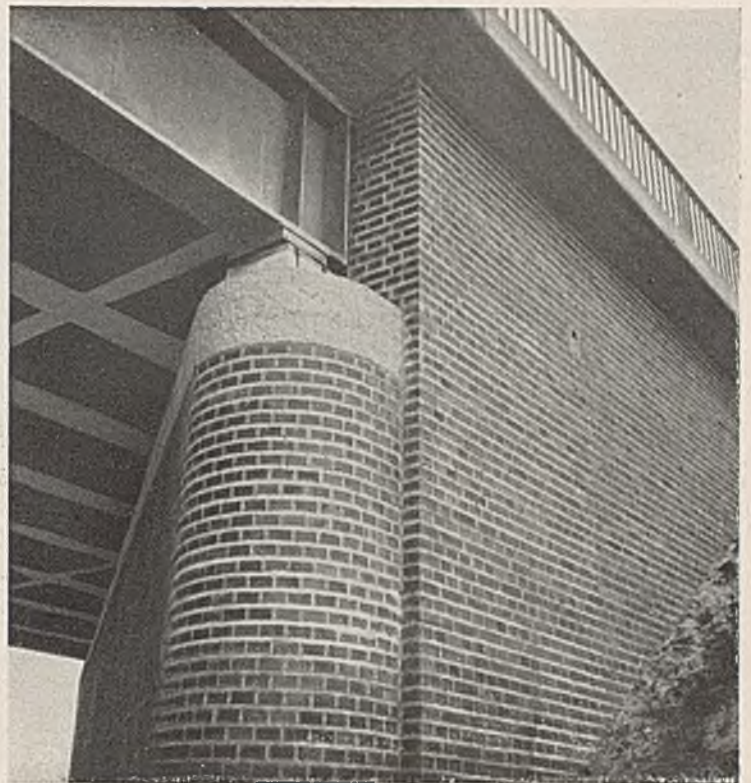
Schiefe Brücke mit geschweißtem Überbau und mit Widerlagern mit Parallelfügeln.
